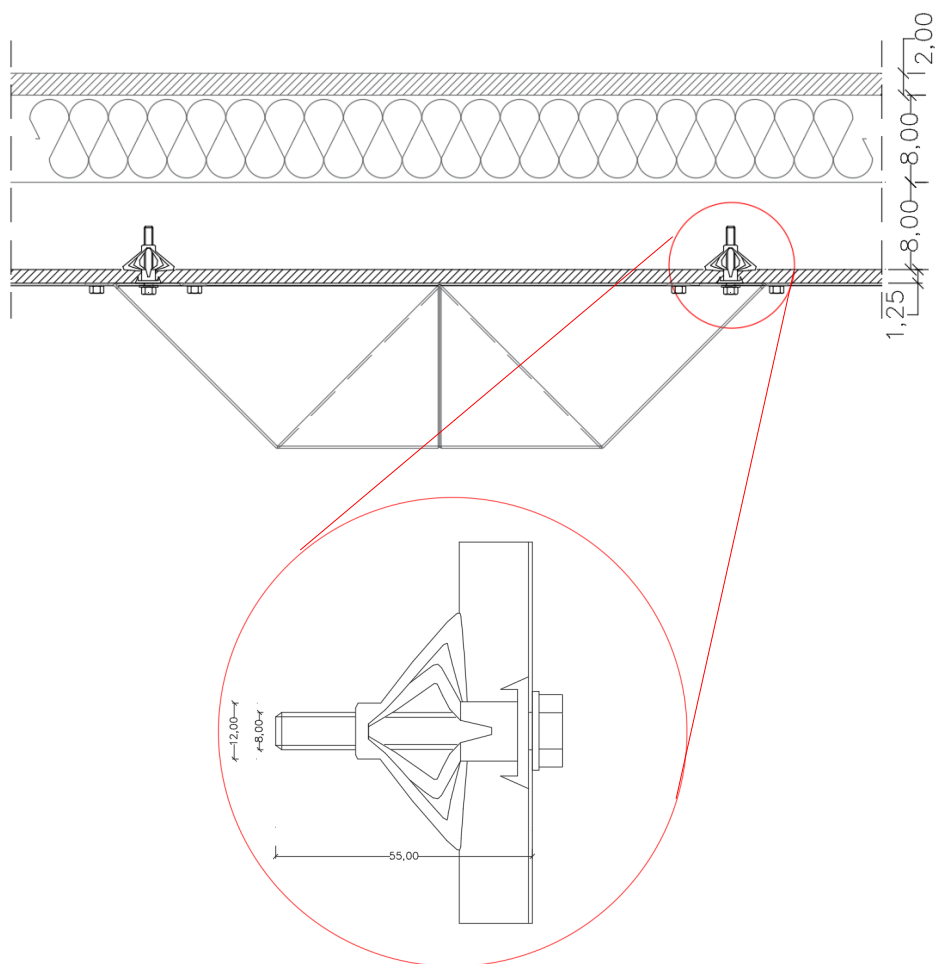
Sezione orizzontale installazione tipo con dettaglio tassello superiore
